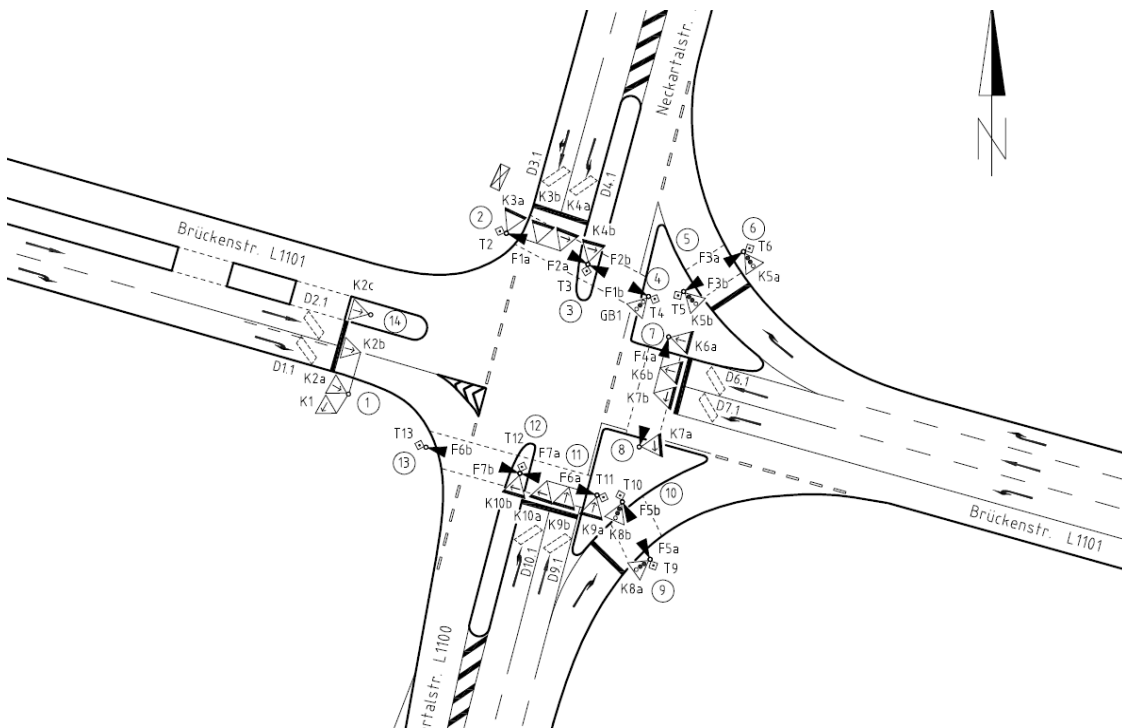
Lageplan LSA L1100/ Brückenstraße
